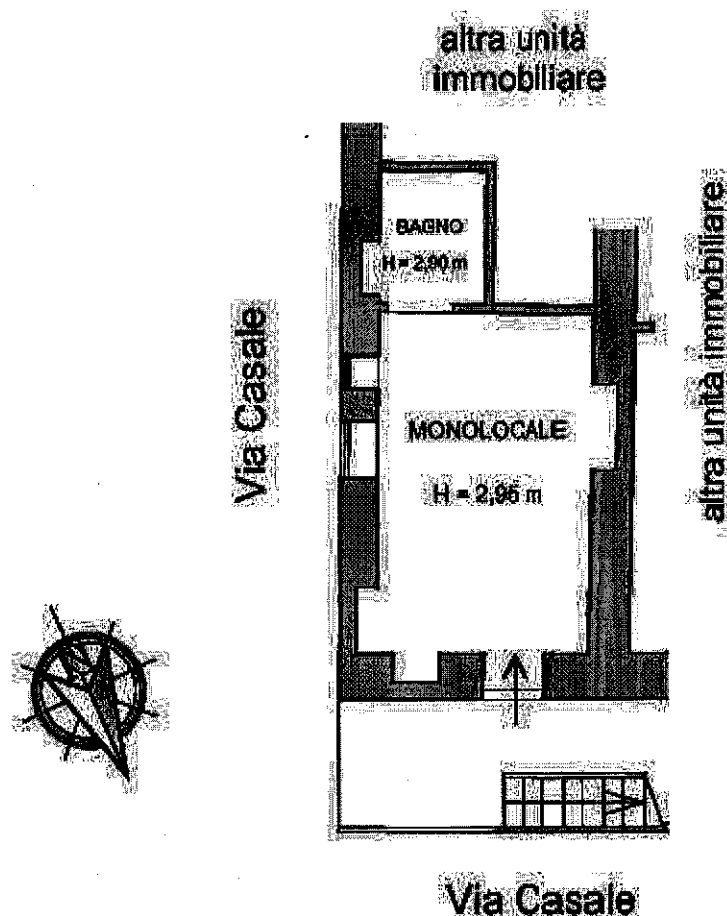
LOTTO 2 – planimetria monocale a piano terra
